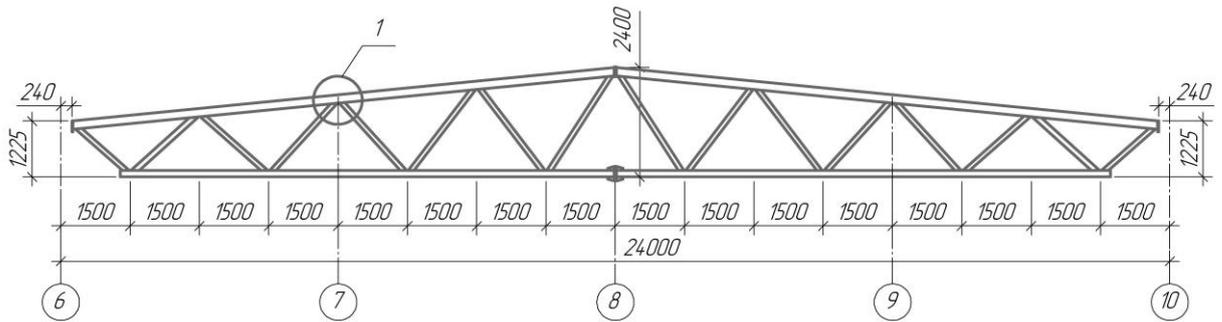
Геометрическая схема фермы с обозначением узла 1
